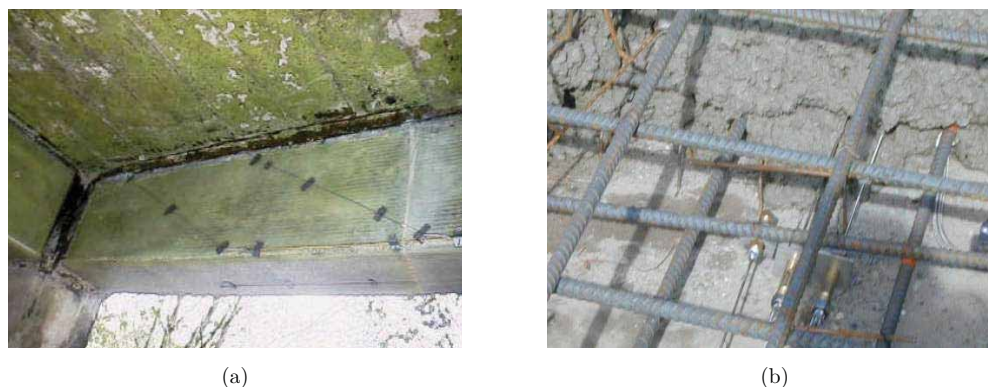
Sensores de deformação instalados em elementos de betão: a) instalação externa à superfície; b) instalação interna embebida no betão (Méndez e Graver, 2007).
